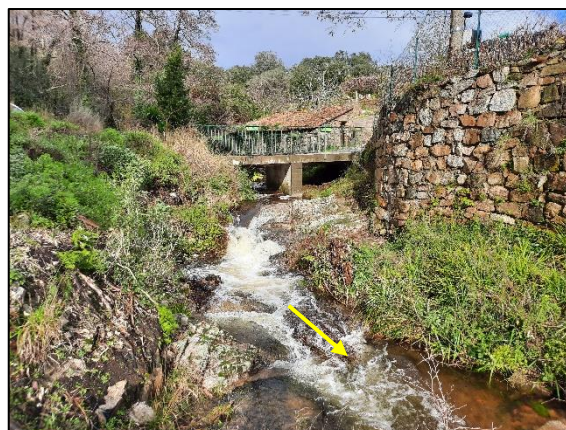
Ouvrage de traversée du ruisseau de TINTURAGGIO (EXU 26)
